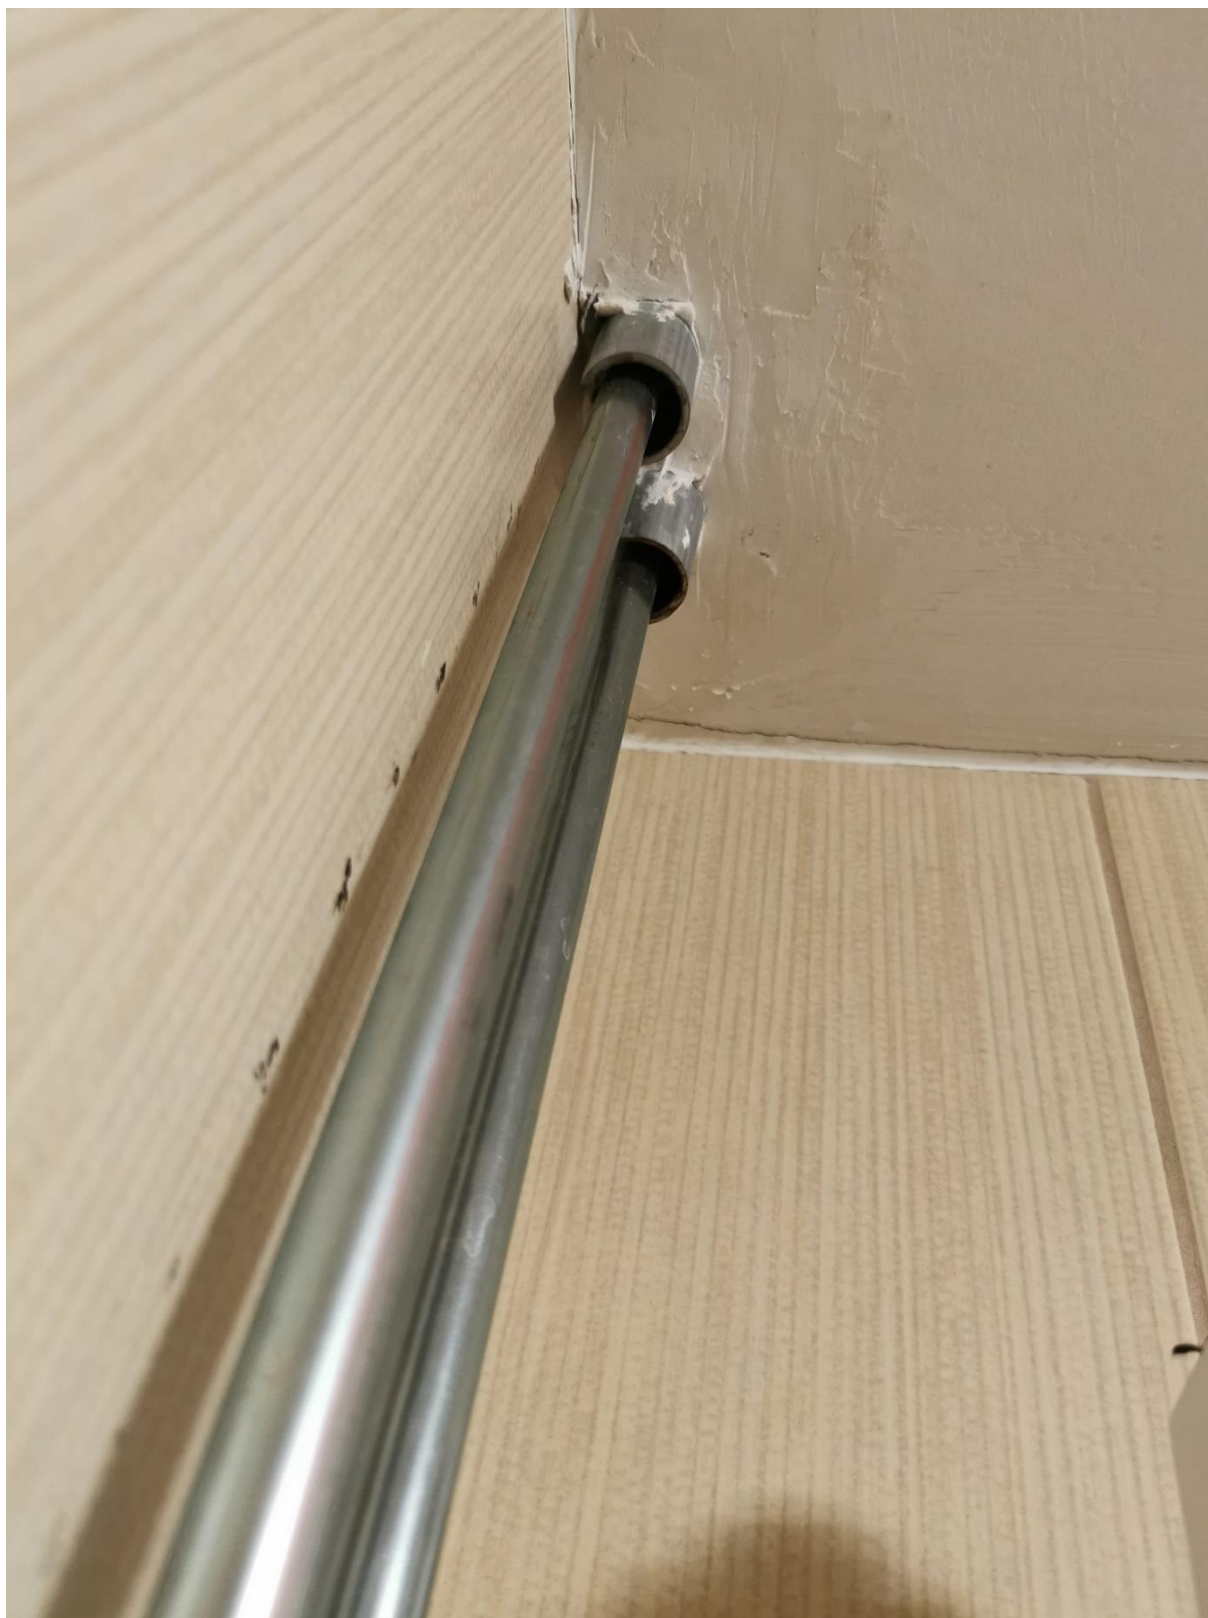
2.4C – brak odtworzenia do stanu pierwotnego (glazura)
